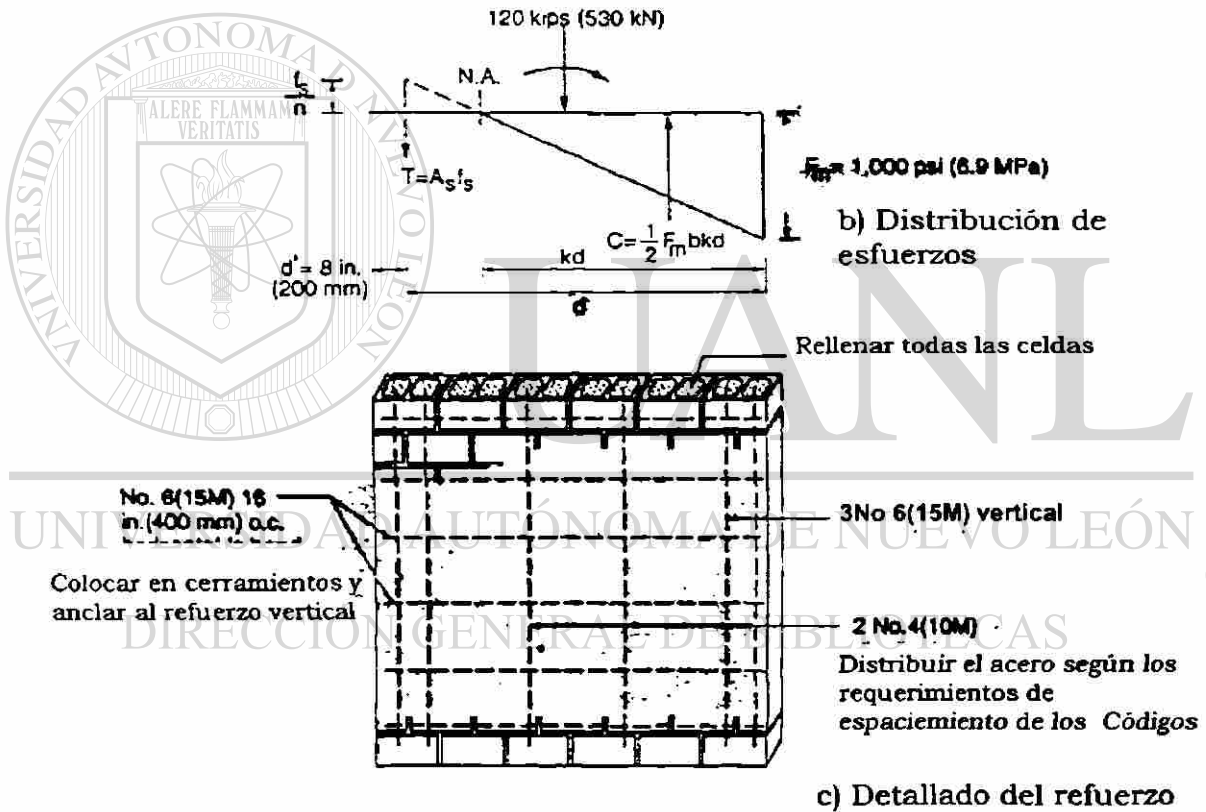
Diseño por esfuerzos de trabajo de un muro cortante de mampostería del ejemplo 7.1.
